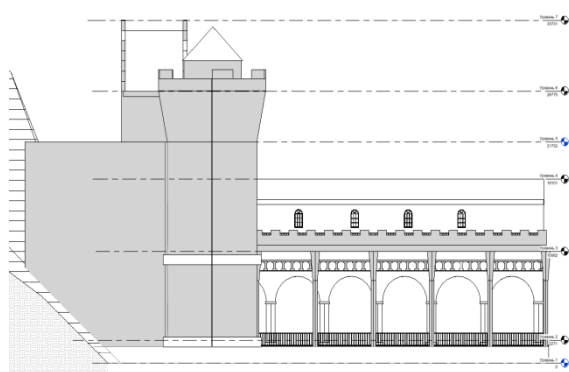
Архитектурно-планировочное решение (фасад - западный)
